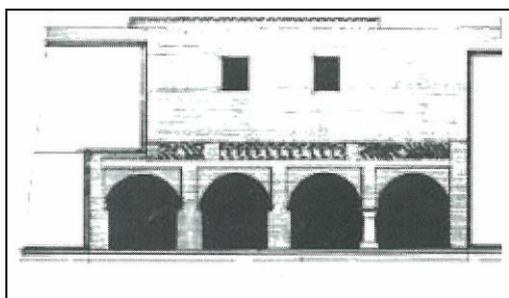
Galerie avec arcades et ouverture à l'étage élément d'enrichissement de la façade urbaine de la
